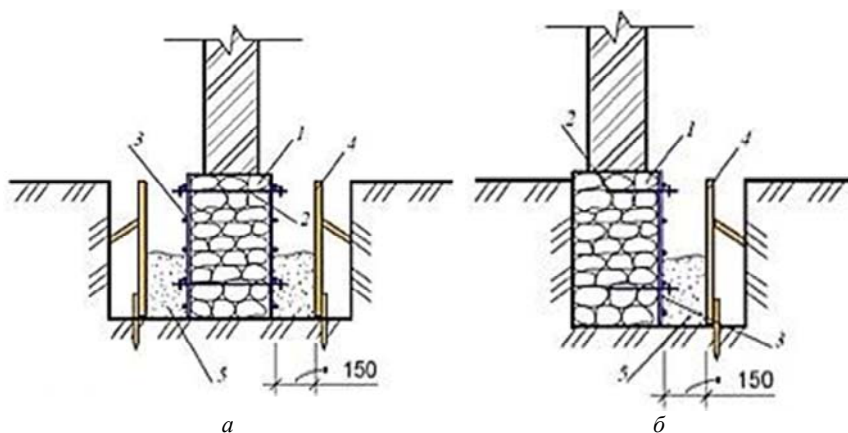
Усиление бутовых фундаментов путем устройства железобетонной обоймы:
